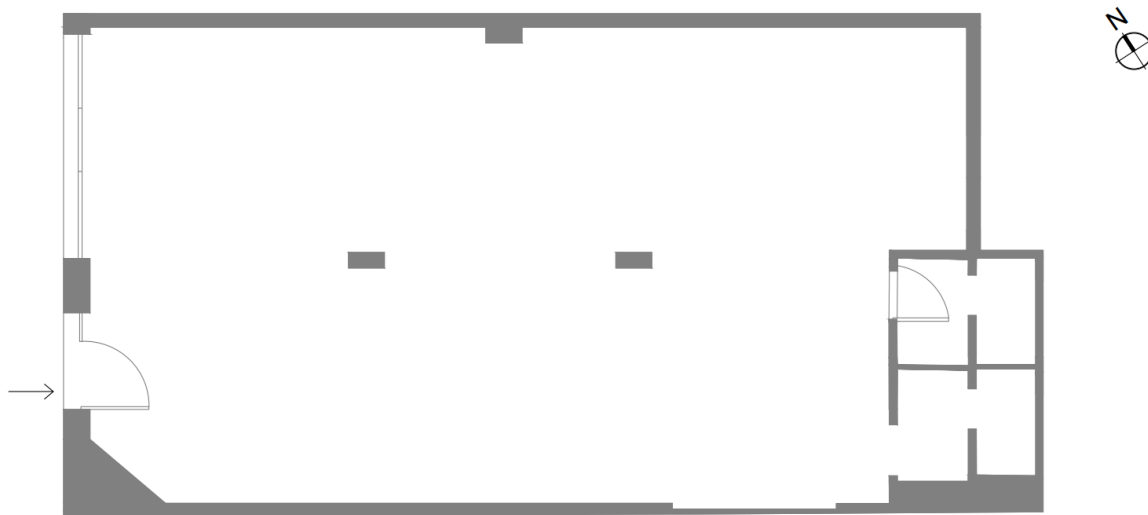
Planta do Existente. Fonte: Rafael Costa
